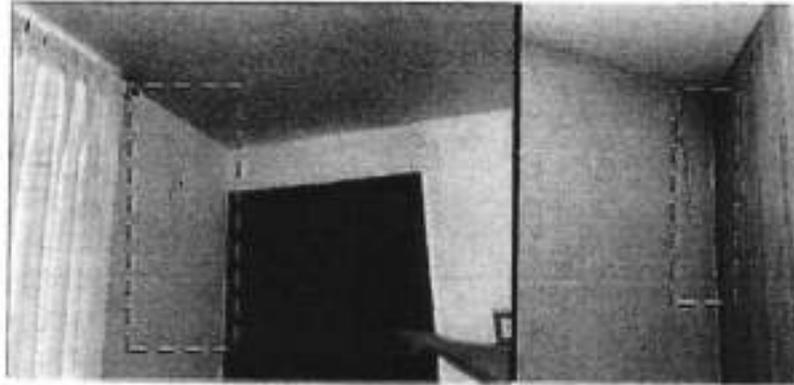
Fisura típica en muro perimetral (costado occidental) del apartamento 101 predio P1 (patio de ropas).
